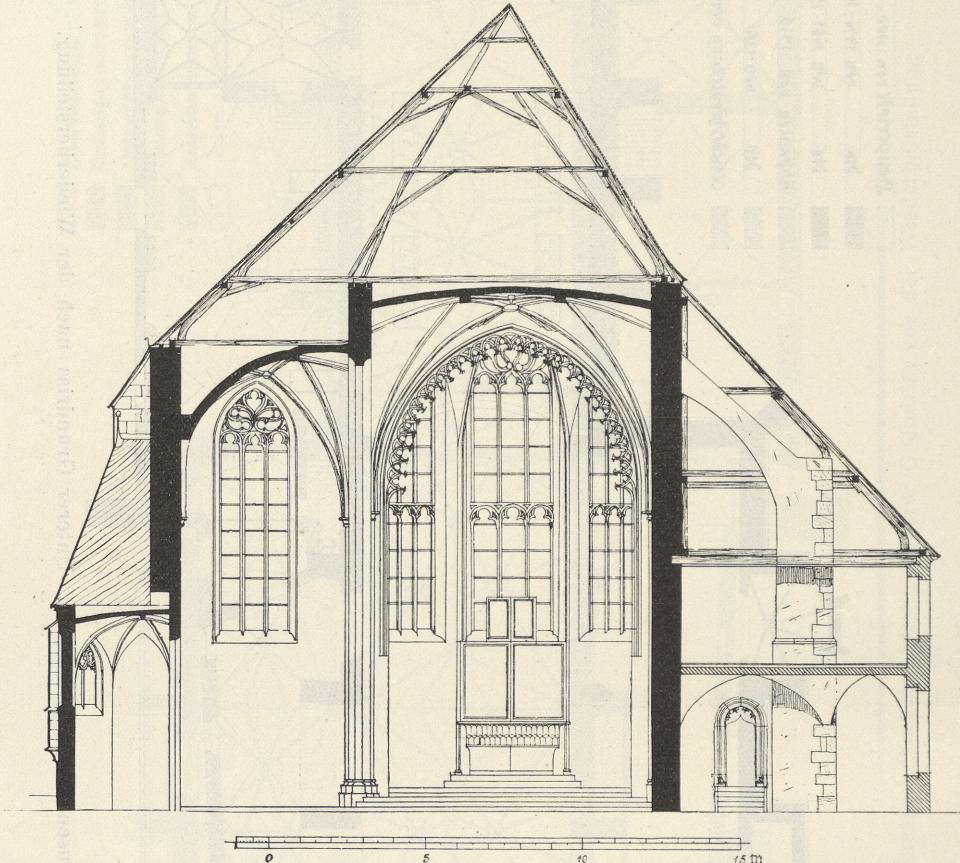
Clausen. Wallfahrtskirche. Schnitt mit wiederhergestelltem Strebessystem.
